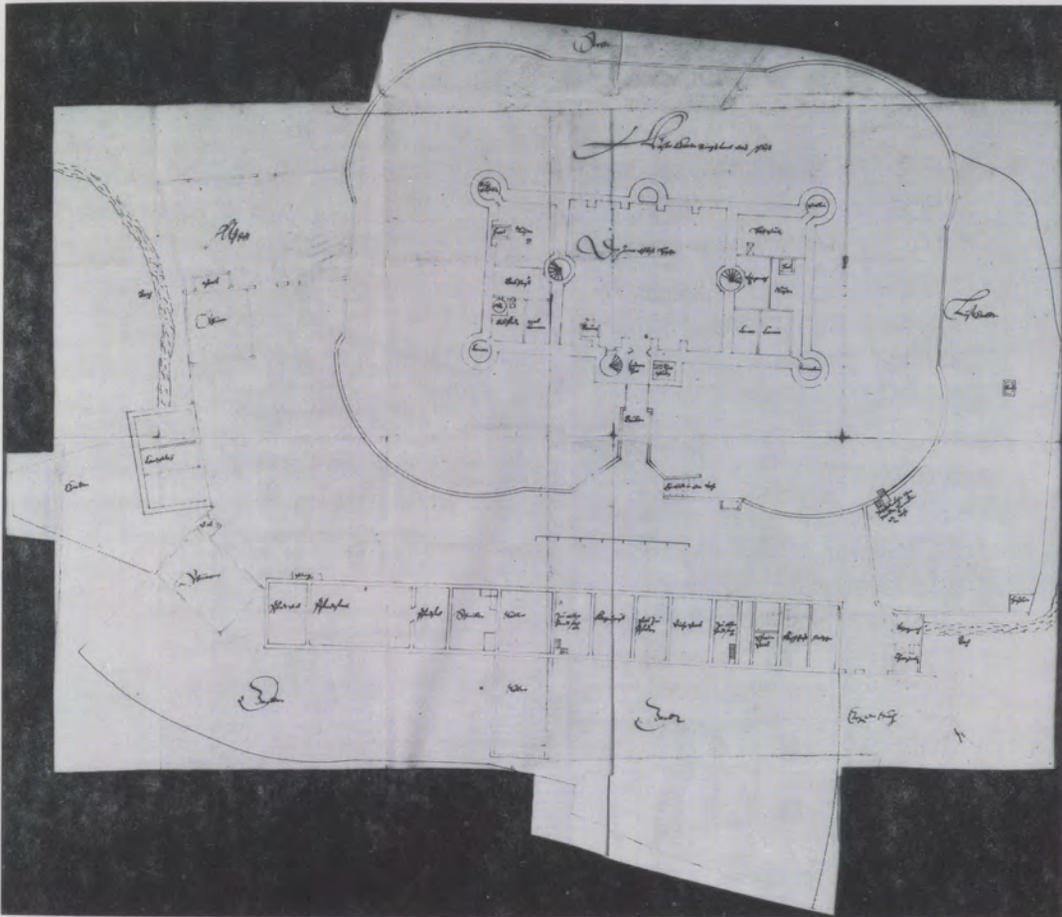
Schloß Pfdelbach mit Nebengebäuden und Umgebung. Erdgeschoßgrundriß, gezeichnet von Gerog Kern als Beilage zur Beschreibung des Schlosses, erstellt am 26. September 1614 anlässlich einer Teilung. Der Grundriß des Südflügels ist spiegelverkehrt. Neben dem Tor ist im Schloßhof der Brunnen vor der Küche dargestellt. Zu erkennen ist, daß an Stelle des heutigen inneren Brückenbogens eine hölzerne Schlagbrücke vorhanden ist. Im äußeren Hof ist bei dem Eintritt in den Wassergraben ein rechteckiger Brunnentrog gezeichnet. HZAN 1. Wa XIII D 33
